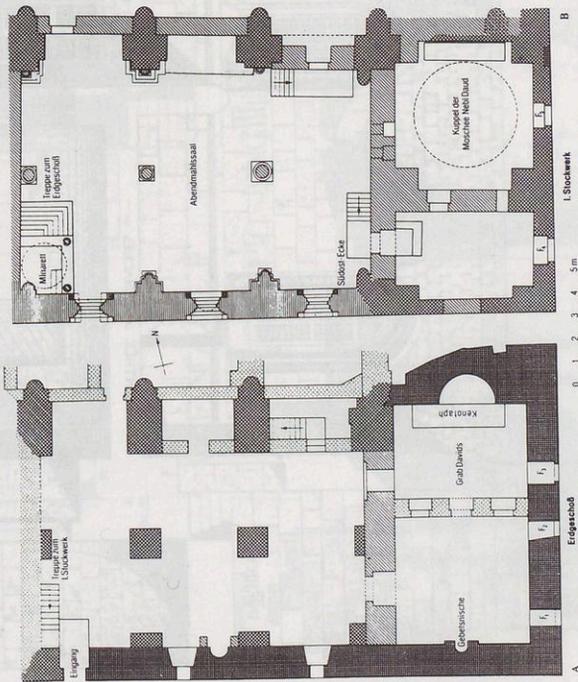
Coenaculum, Grundriß in Erd- und Obergeschoß (nach Kroll).
